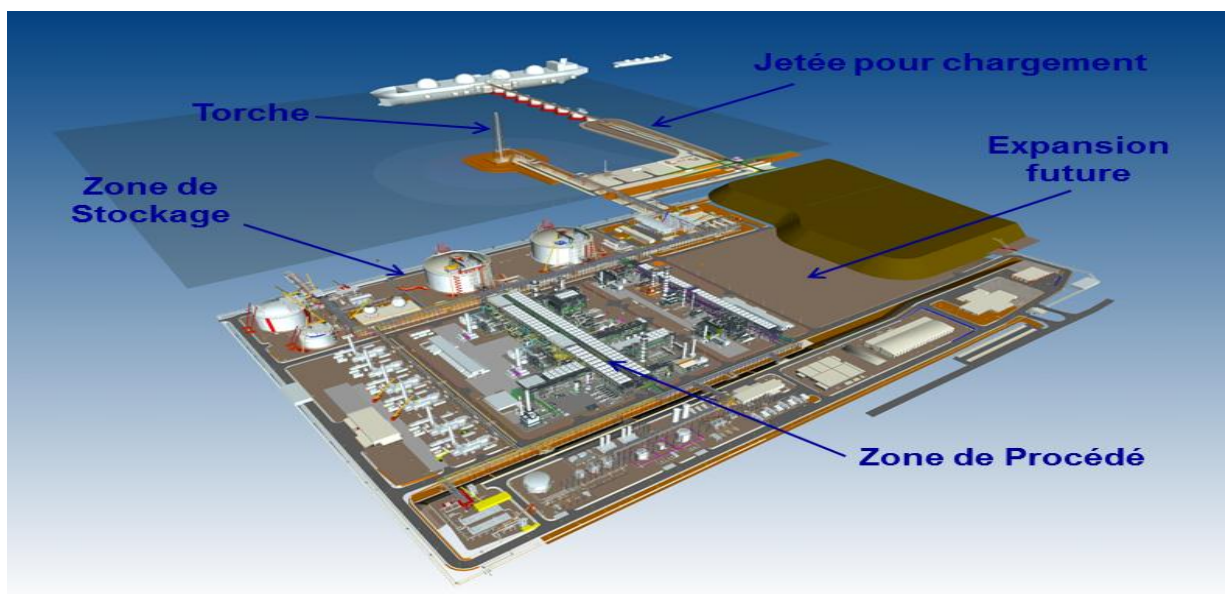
Vue d'ensemble 3D de l'usine GL3/Z
